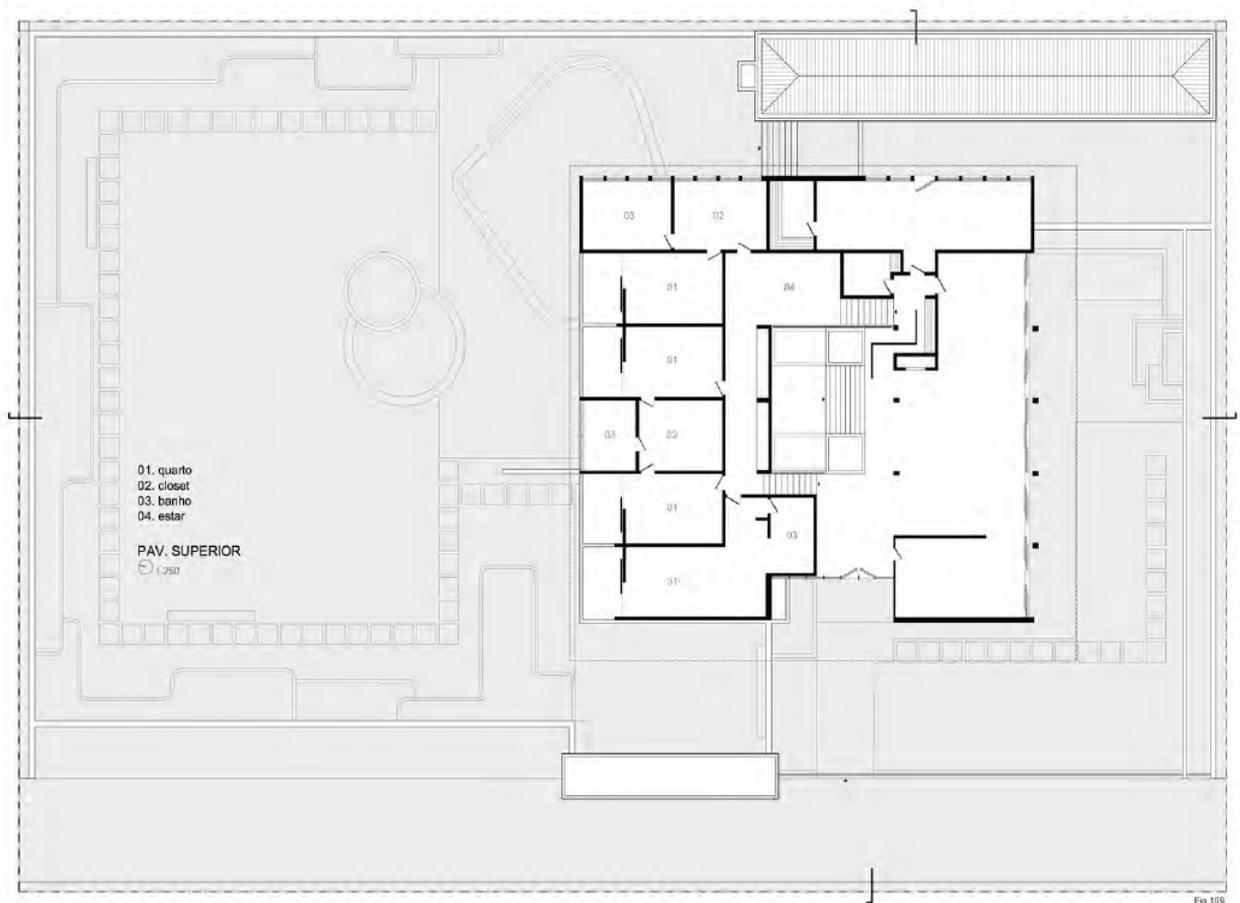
| PLANTA BAIXA SUPERIOR CASA ABDALA ABRÃO, 1967 – ARQUITETO DAVID LIBESKIND.
